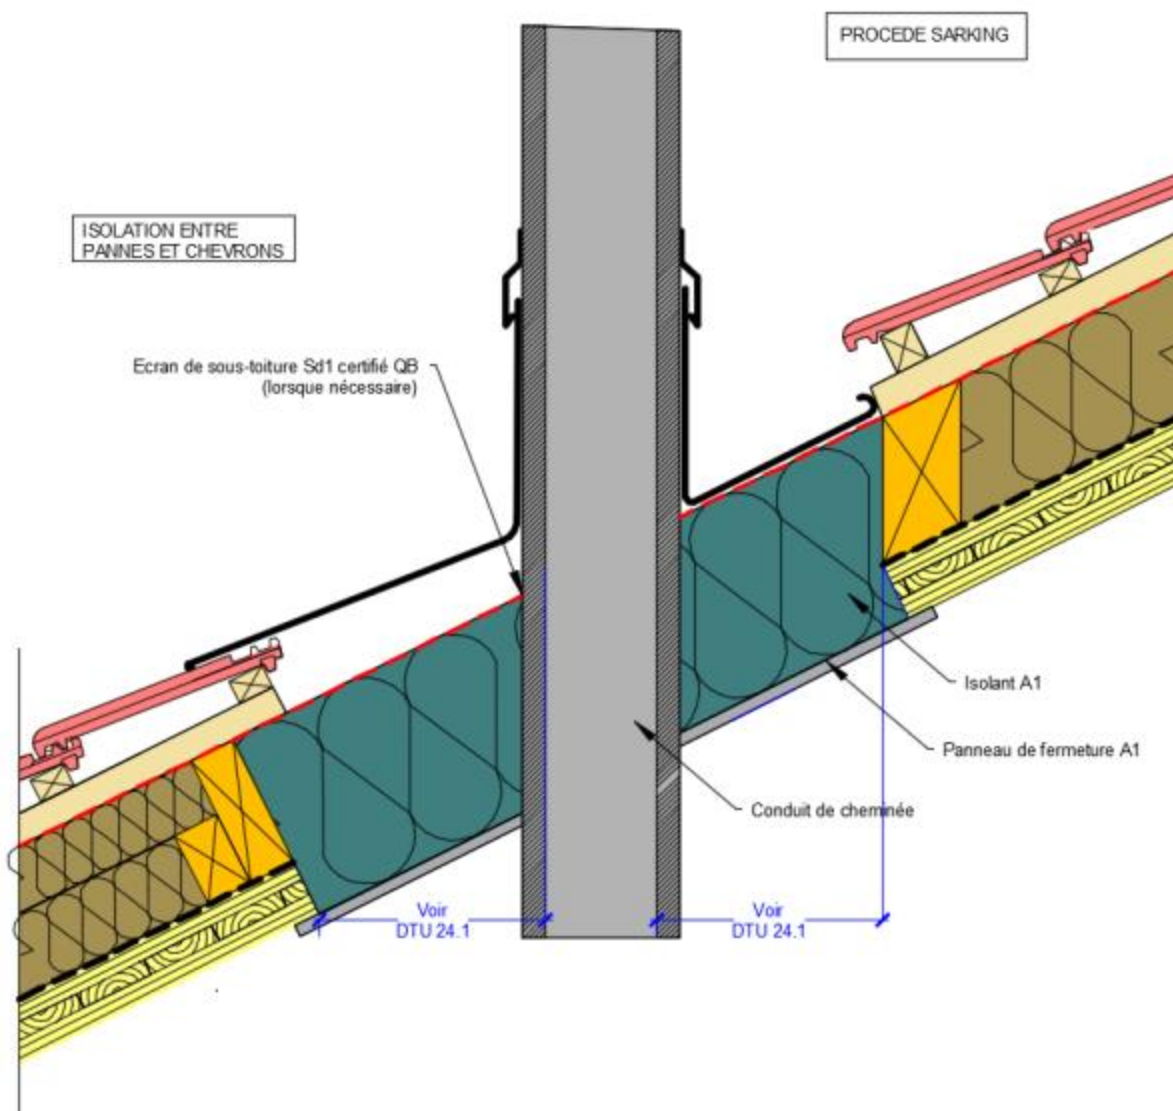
Traversée de conduit de fumée -- Couverture en tuiles
